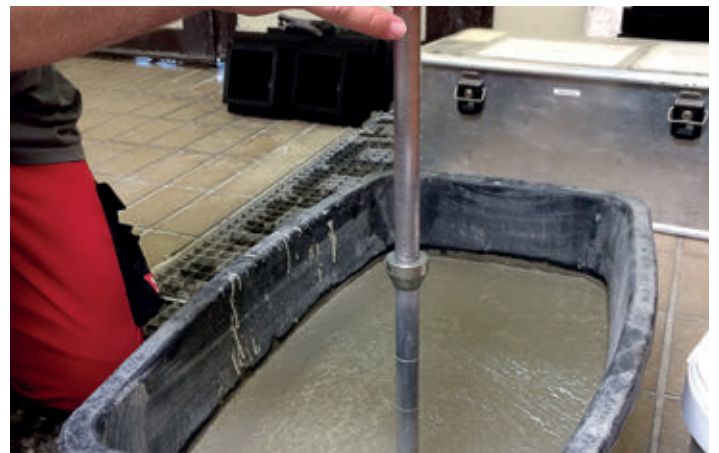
Prüfung des Erstarrungszustandes des Betons mit der Humm-Sonde
